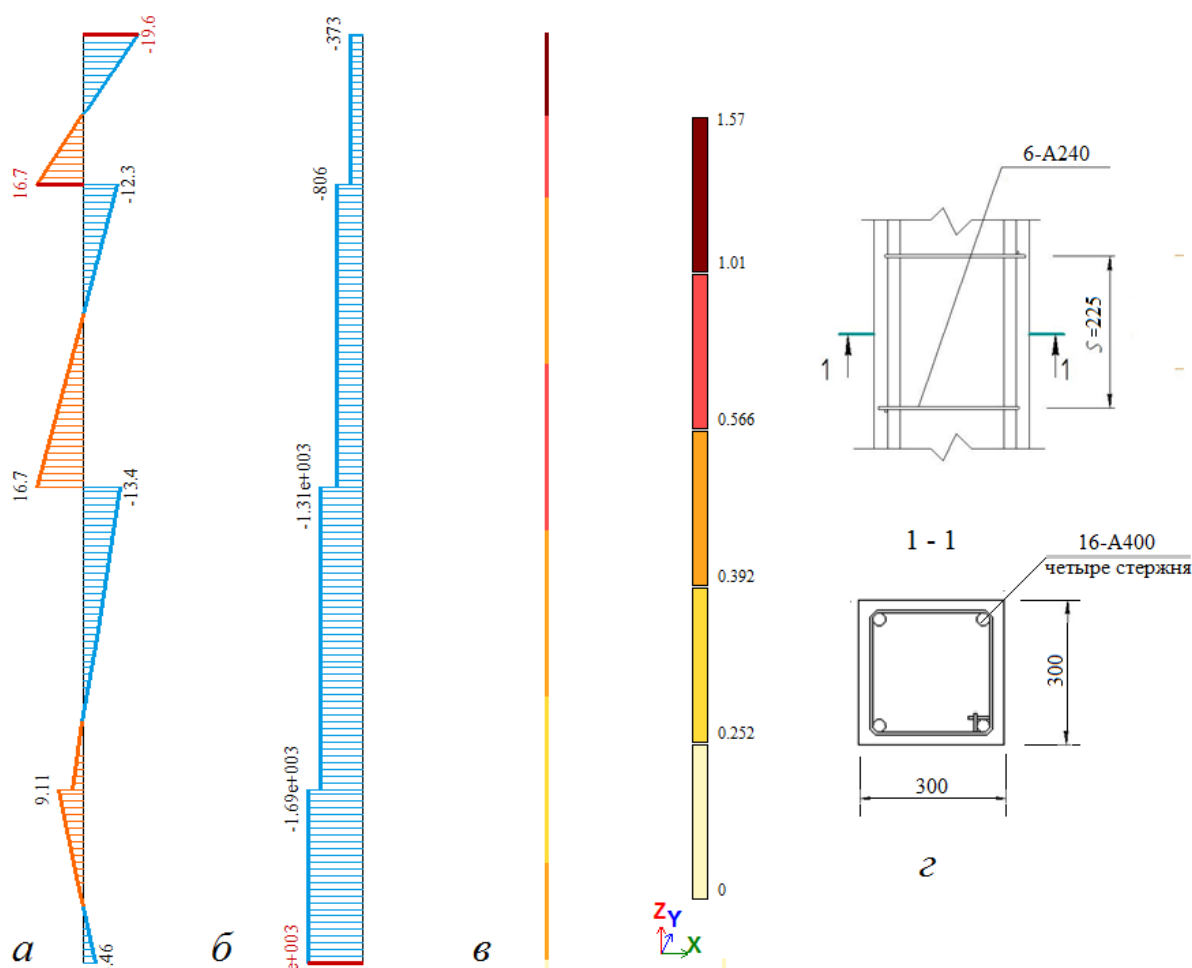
Результаты статического расчета и подбора арматуры для колонны среднего ряда: *а* – эпюра изгибающих моментов в кНм; *б* – эпюра продольной силы в кН; *в* – площадь продольной арматуры колонны в см²; *г* – схема армирования
